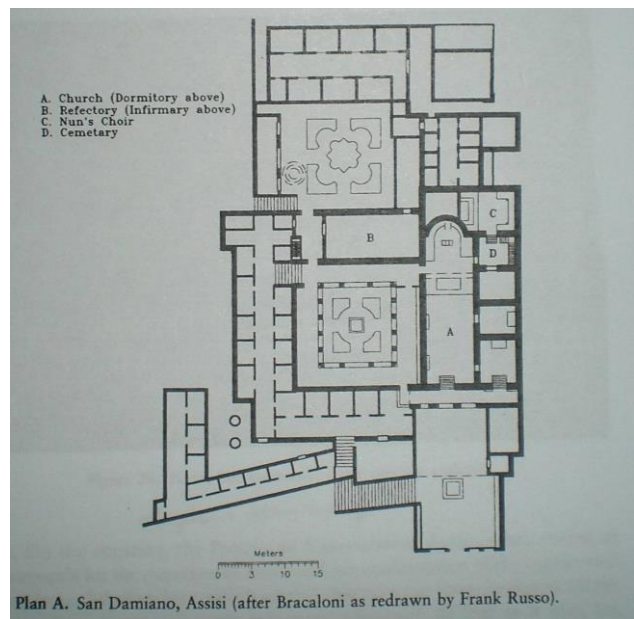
Grundriss, San Damiano, Assisi nach Bracaloni
